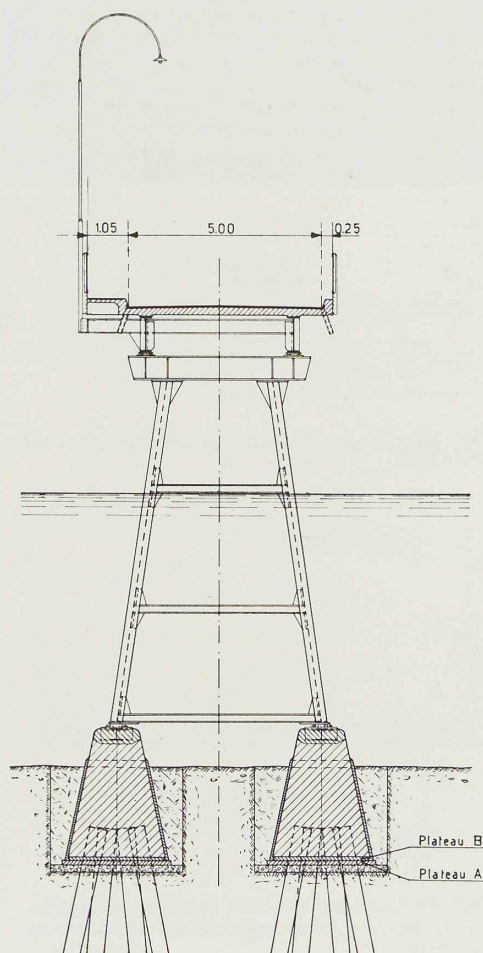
Détails d'une pile du pont de Steinbach montrant notamment les dispositifs adoptés pour les fondations.
